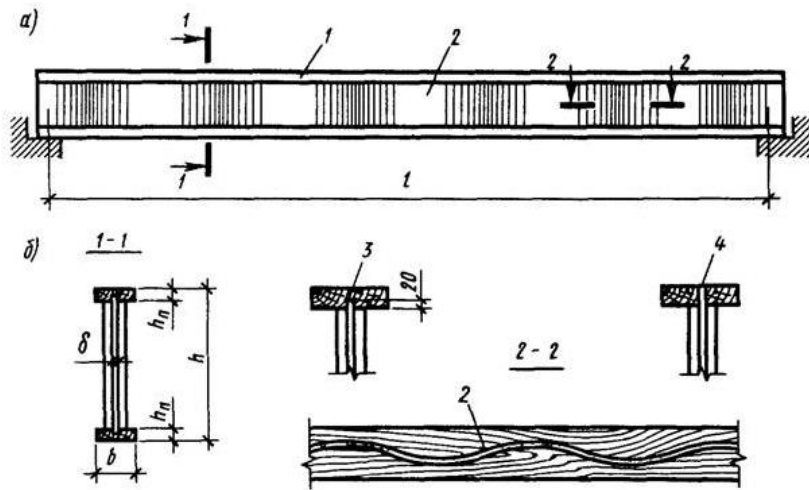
Клеєфанерна балка з хвилястою стінкою: а – фасад; б – січення;
